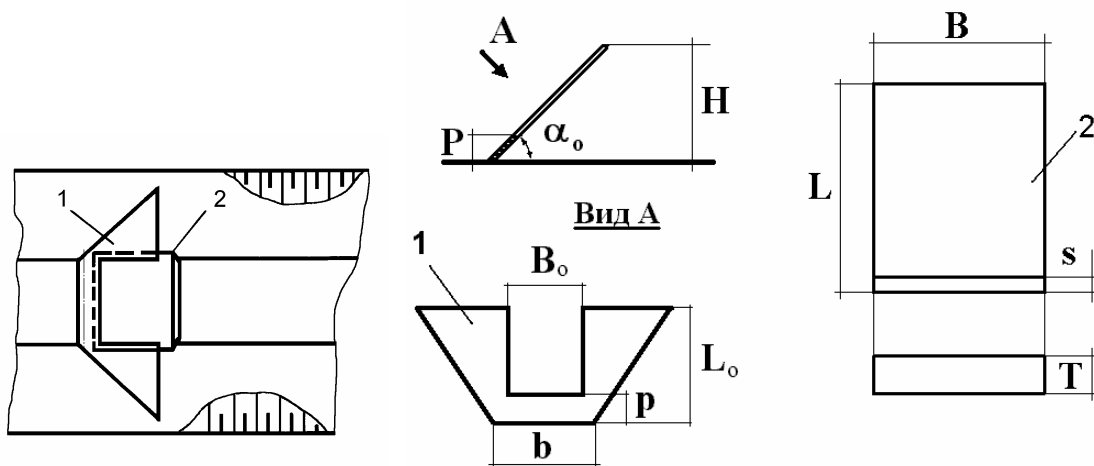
План размещения ППУ в канале, наклонная стенка и поплавок прямоугольного сечения
